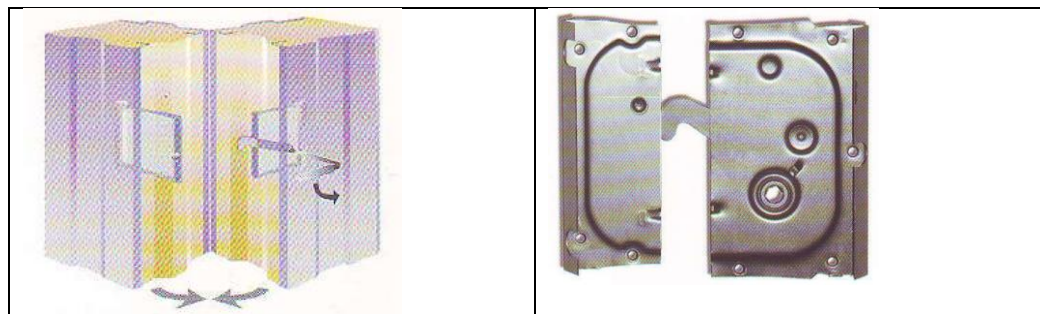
Detalles del Panel aislante tipo Sandwich Fuente: Espiral World S.L
